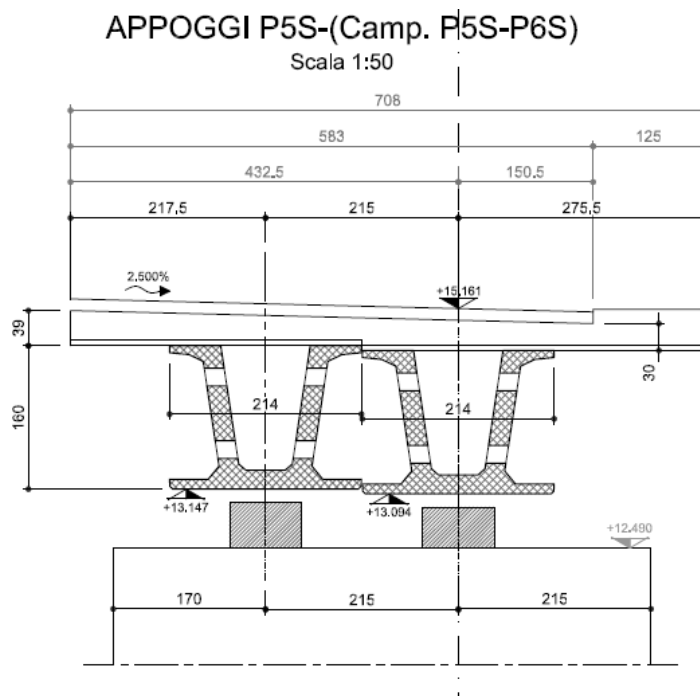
Sezione trasversale Campata 6 (a 2 travi) – Rampa S – P5_S
